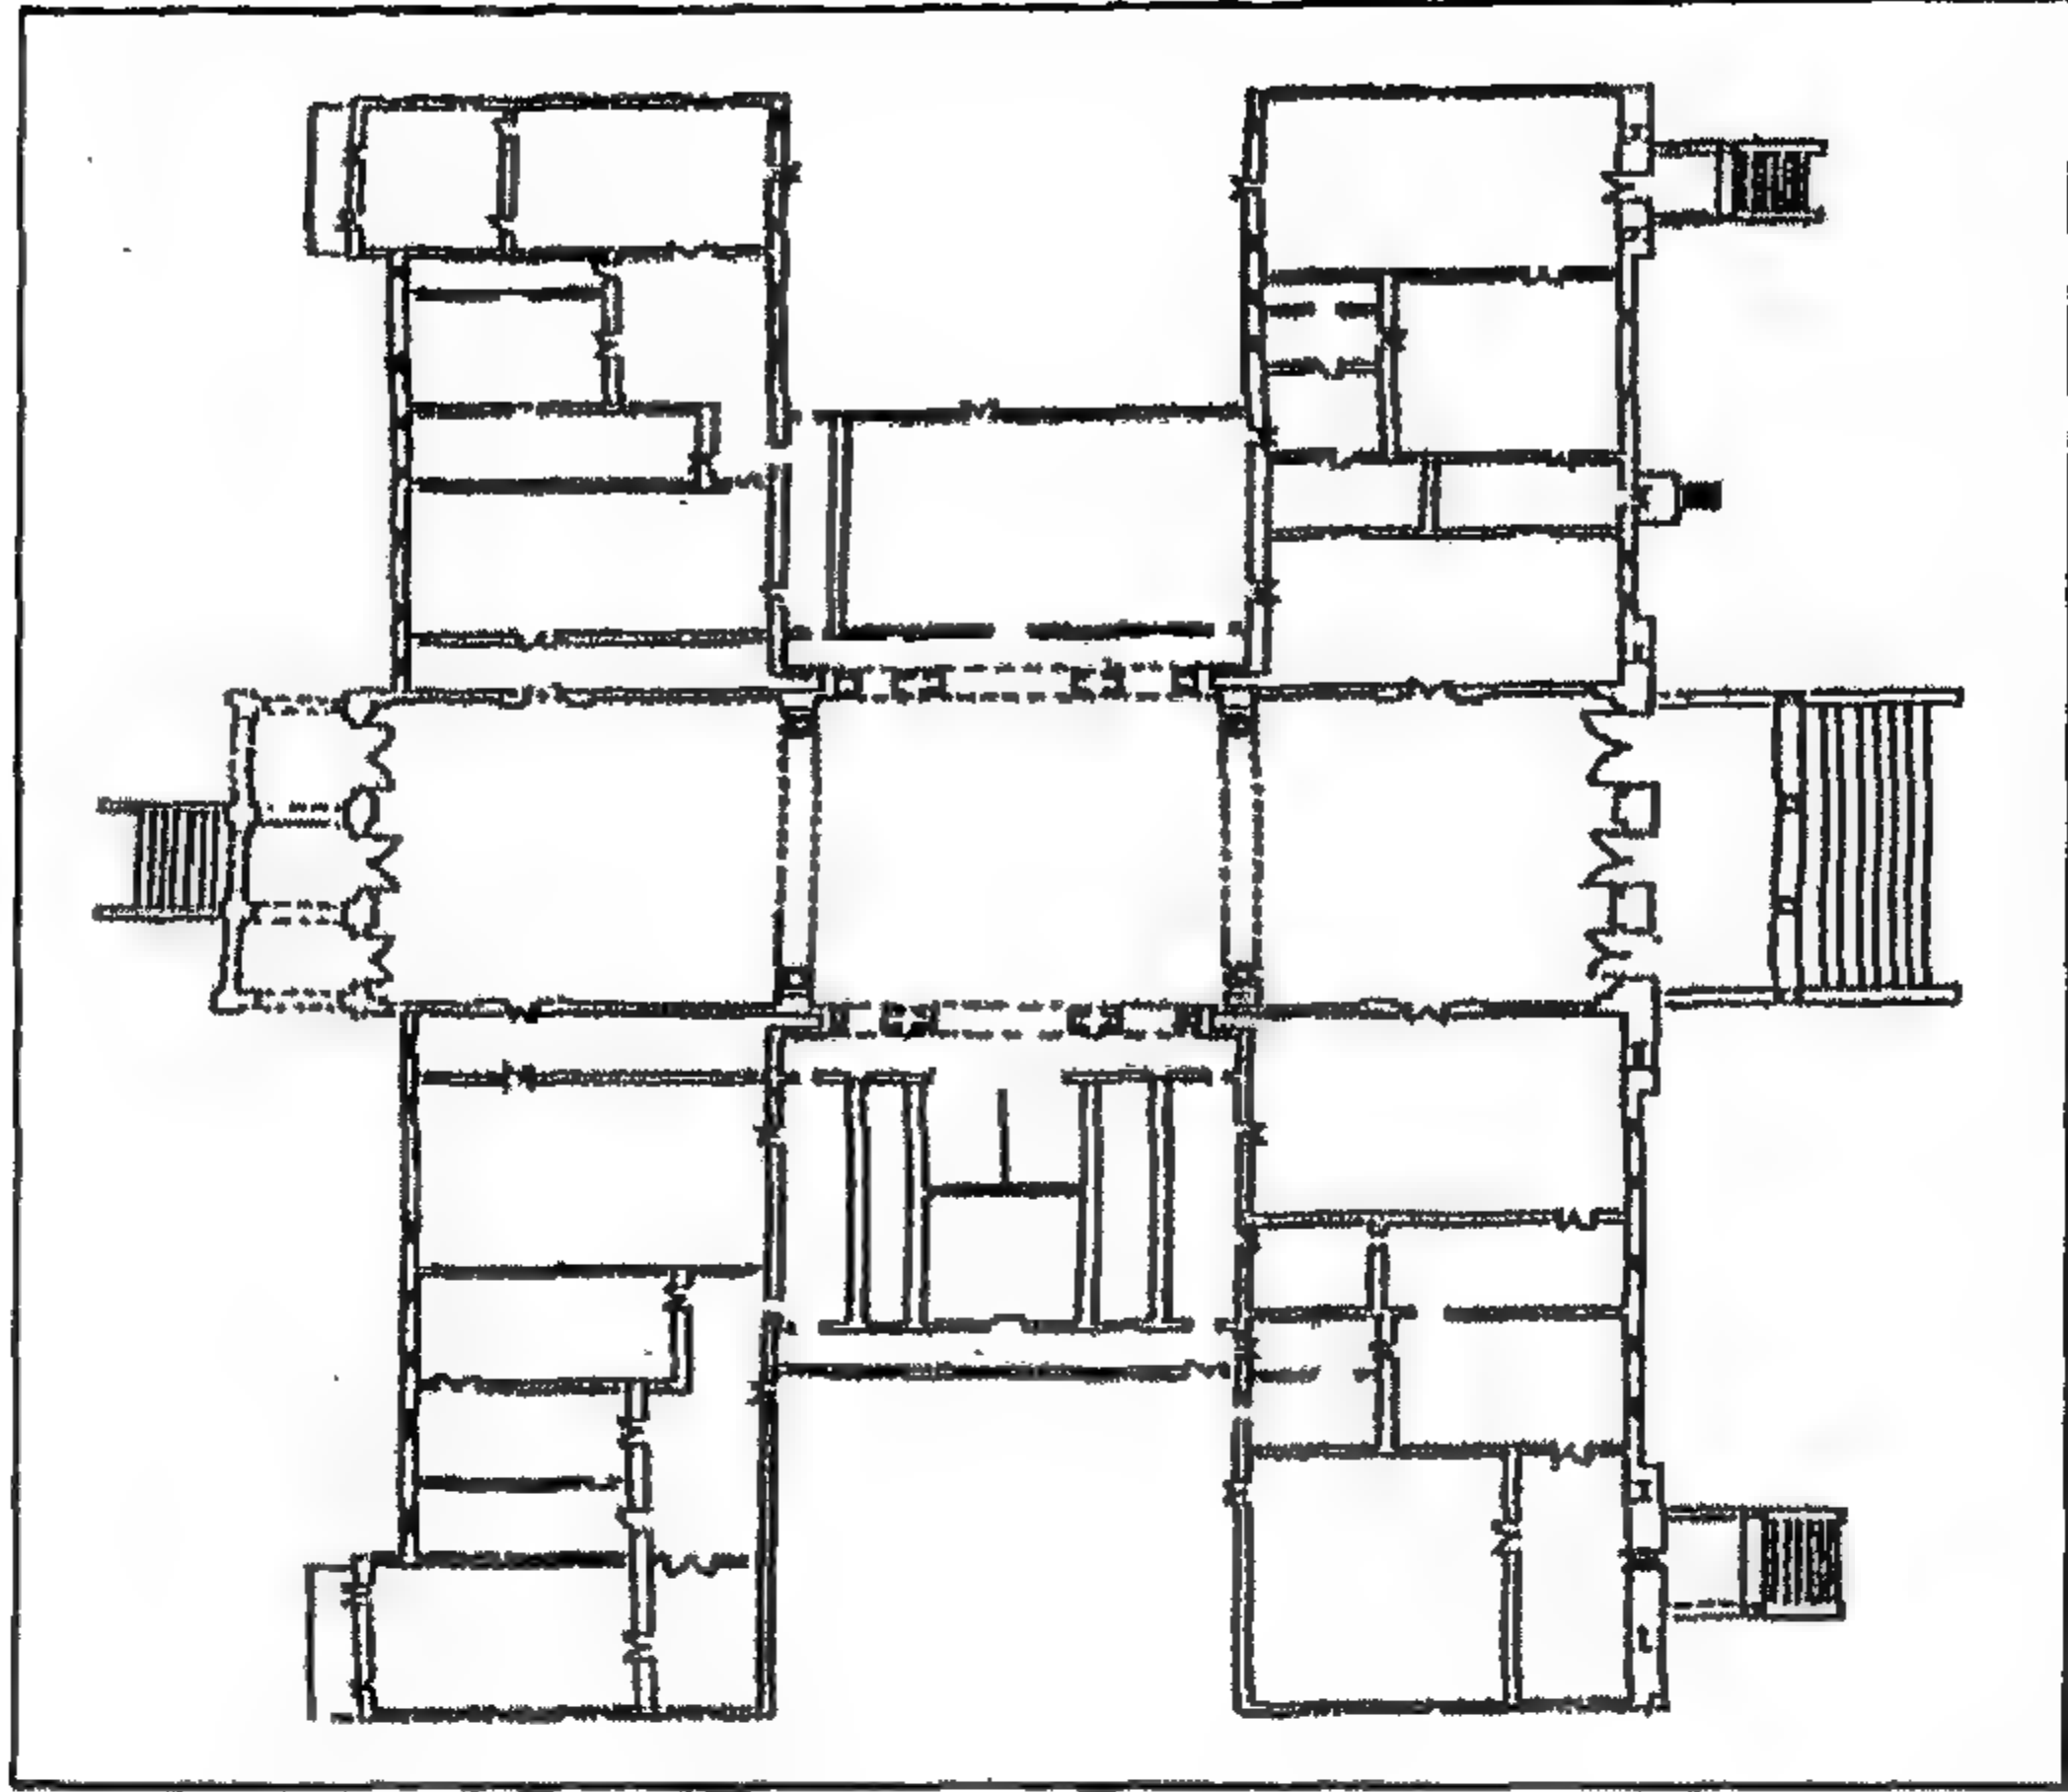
مسقط أفقى الطابق الأرضى لقصر إسماعيل صديق المفتش عن
